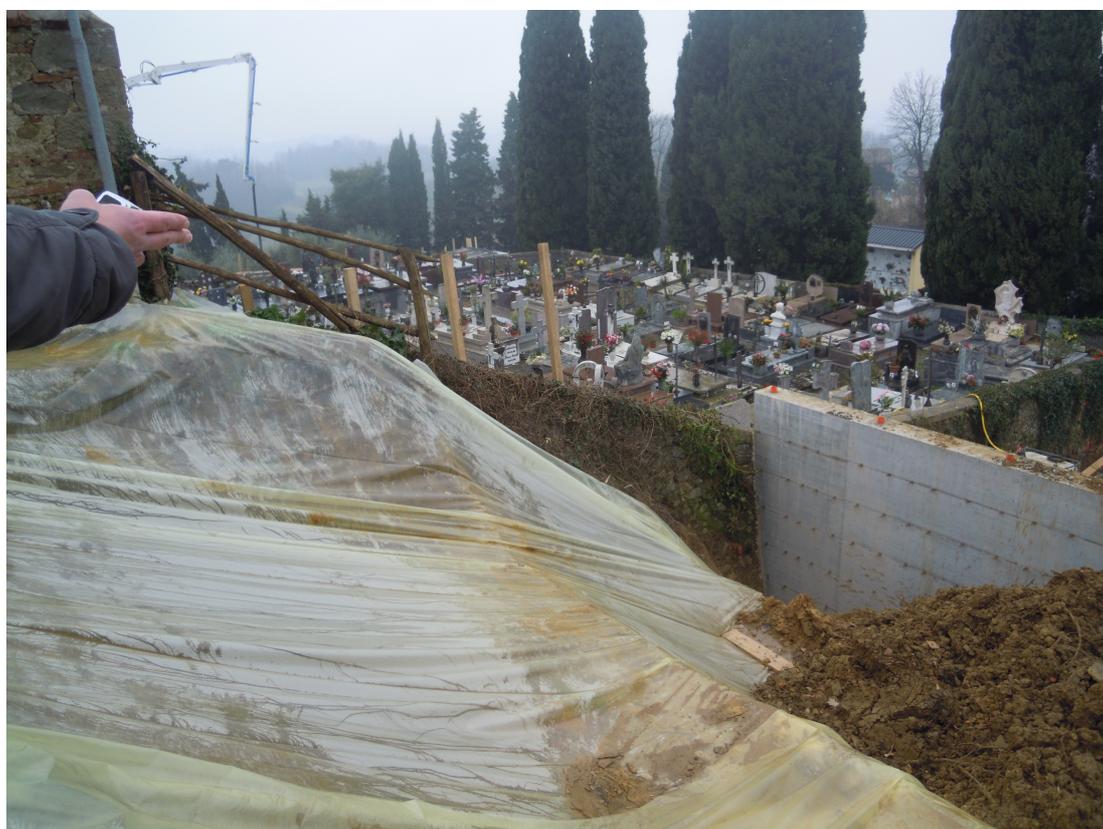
vista del muro lato nord da ricostruire dal lato della scarpata del piazzale della chiesa
